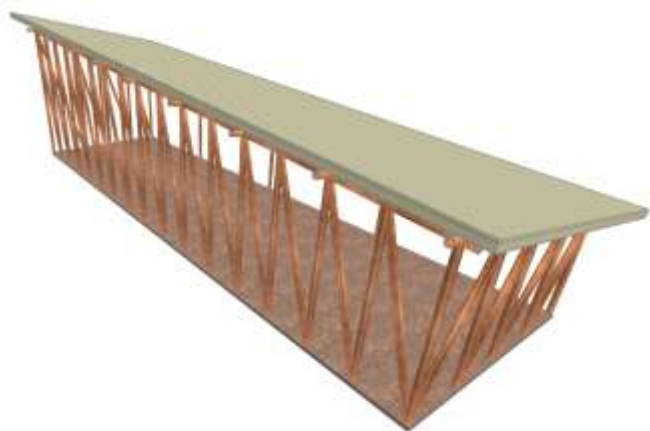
Estructura de Vigas para asentar el Calcreto
